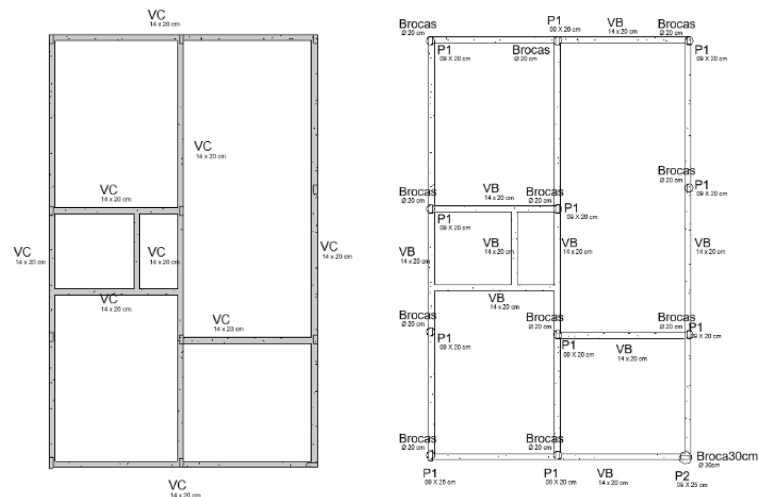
Planta baixa inicial do projeto, modelo adotado na avaliação
